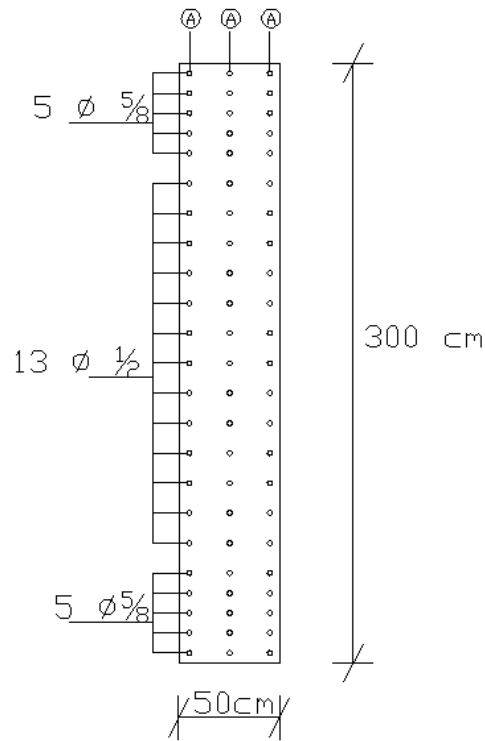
Sección transversal de muro dirección Y nivel PB.
